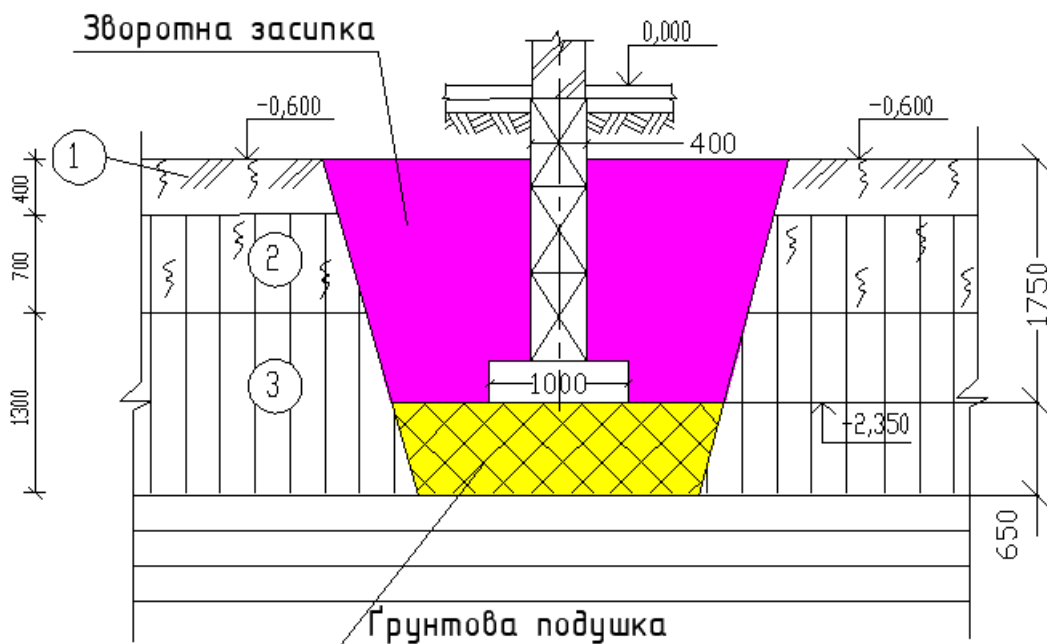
Поперечний розріз фундаменту відомої конструкції
